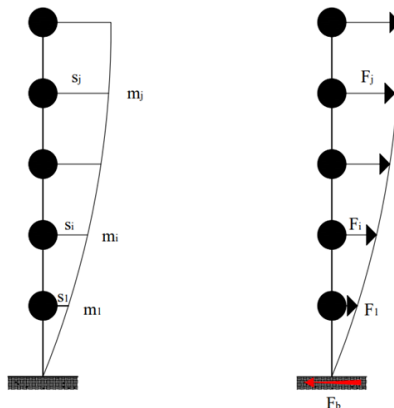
Shpërndarja e forcave sizmike horizontale sipas tonit themelor
